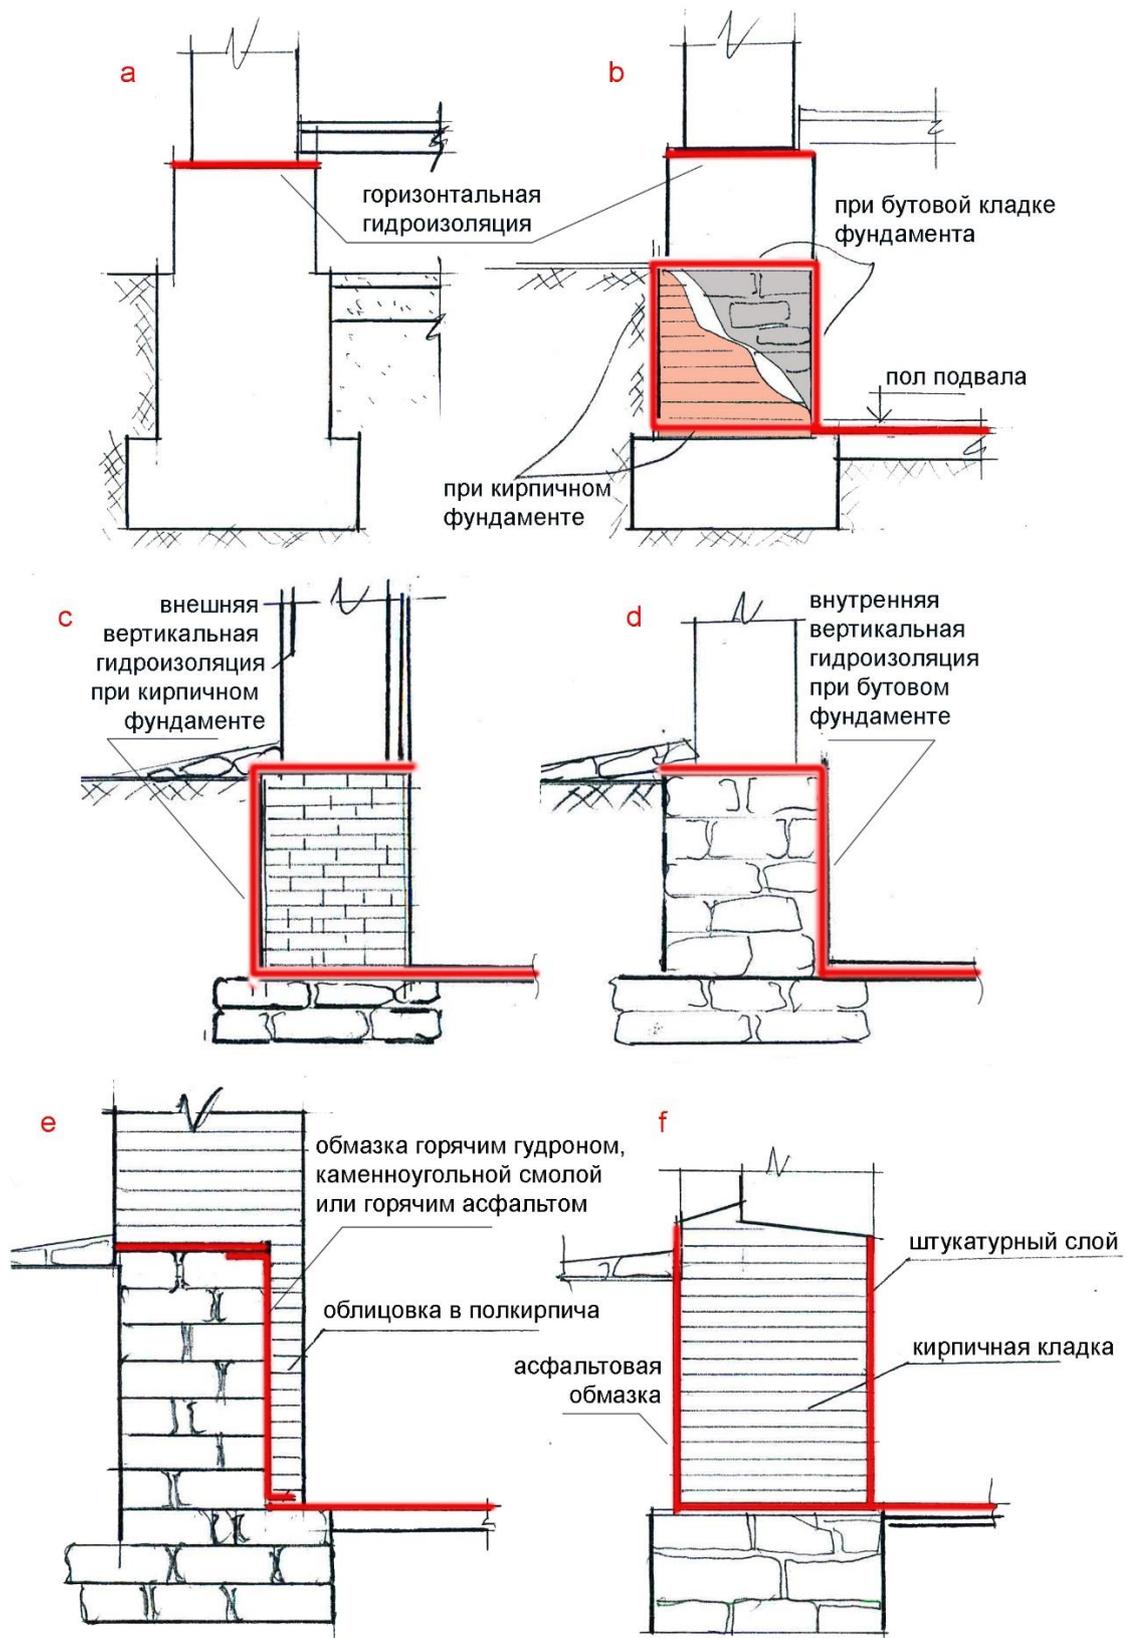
Варианты гидрозащиты стен и подвальных помещений от грунтовой влаги при низком стоянии грунтовых вод и небольшой влажности грунта: а – расположение гидроизоляции при отсутствии подвала; б – ф – расположение гидроизоляции при наличии подвала
